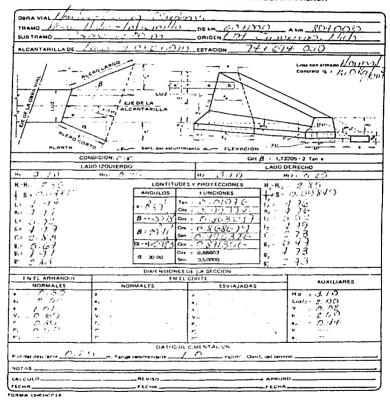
Cálculo de aleros para losa de 4.0 x 2.5 m.
